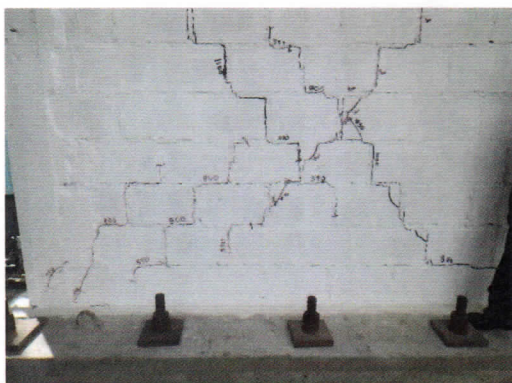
Continuación de grietas diagonales y aparición de una pequeña grieta nueva en la esquina inferior Oeste, vista cara Sur para una distorsión de 1/550.
